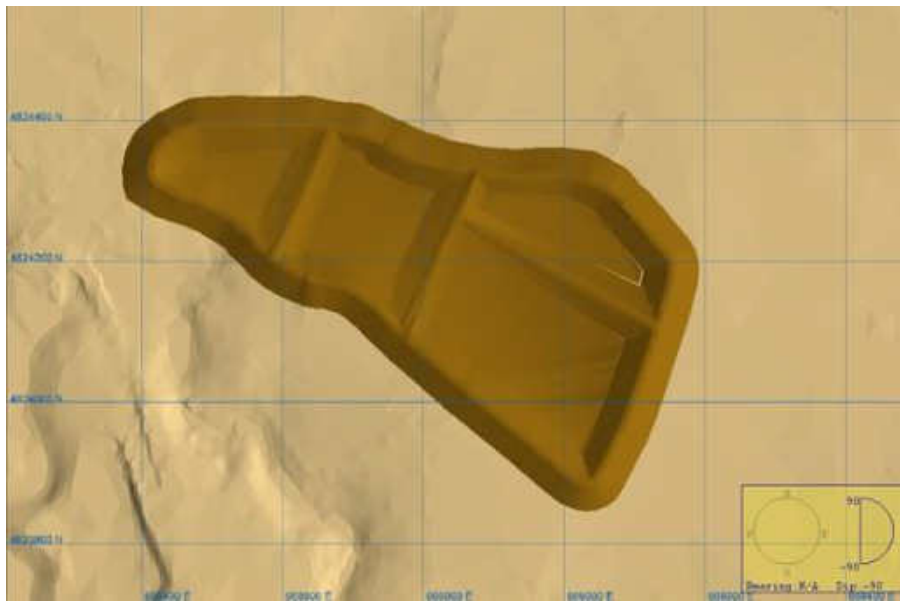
Diseño en planta del depósito apoyado en el terreno.
